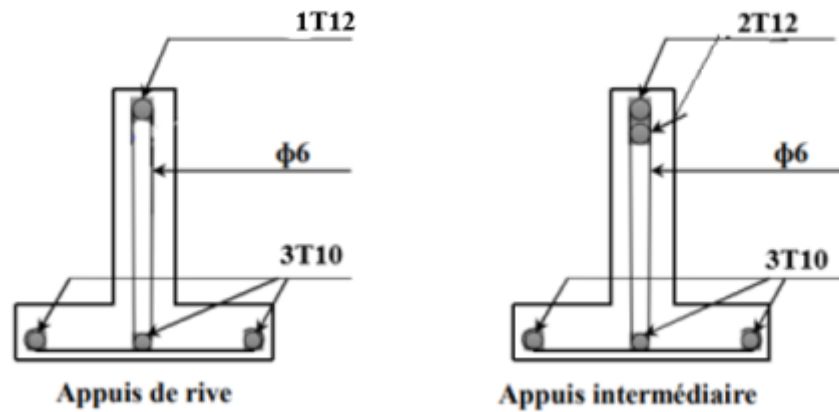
Disposition du ferrailage terrasse accessible.
